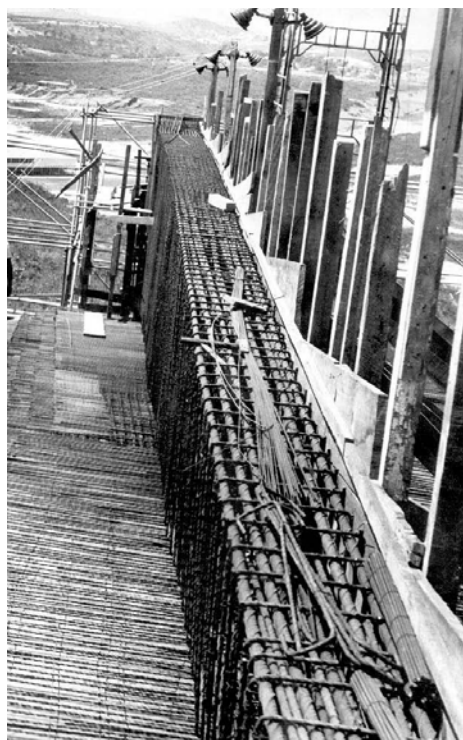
Foto mostrando as armações de uma viga da cobertura tirada durante a construção do Mineirão
